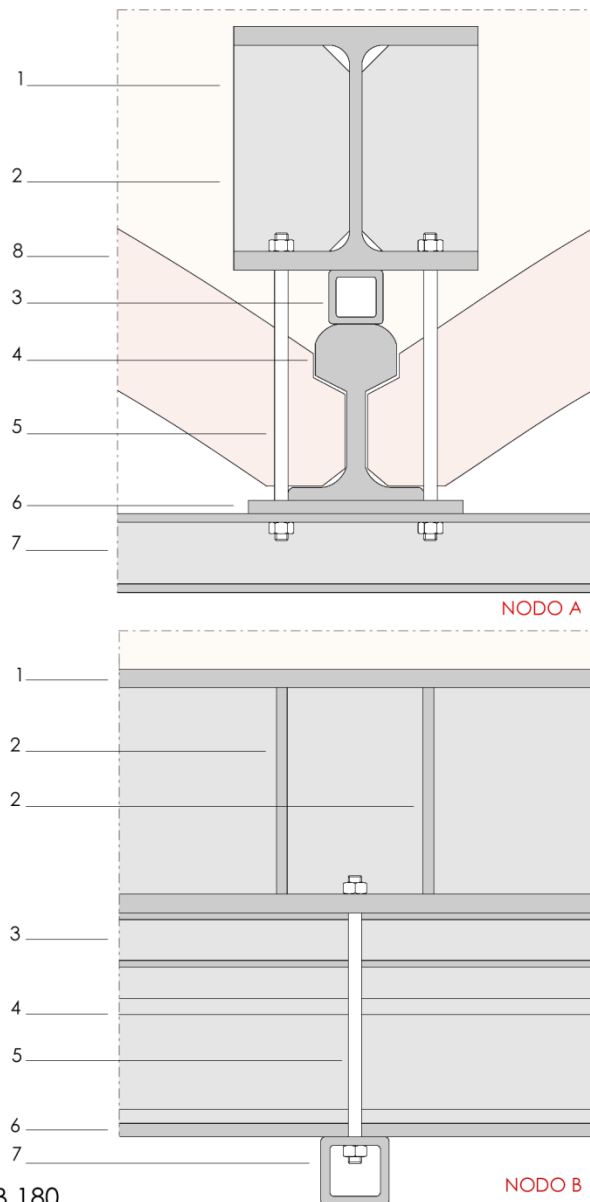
Sezione trasversale e longitudinale dell'intervento
